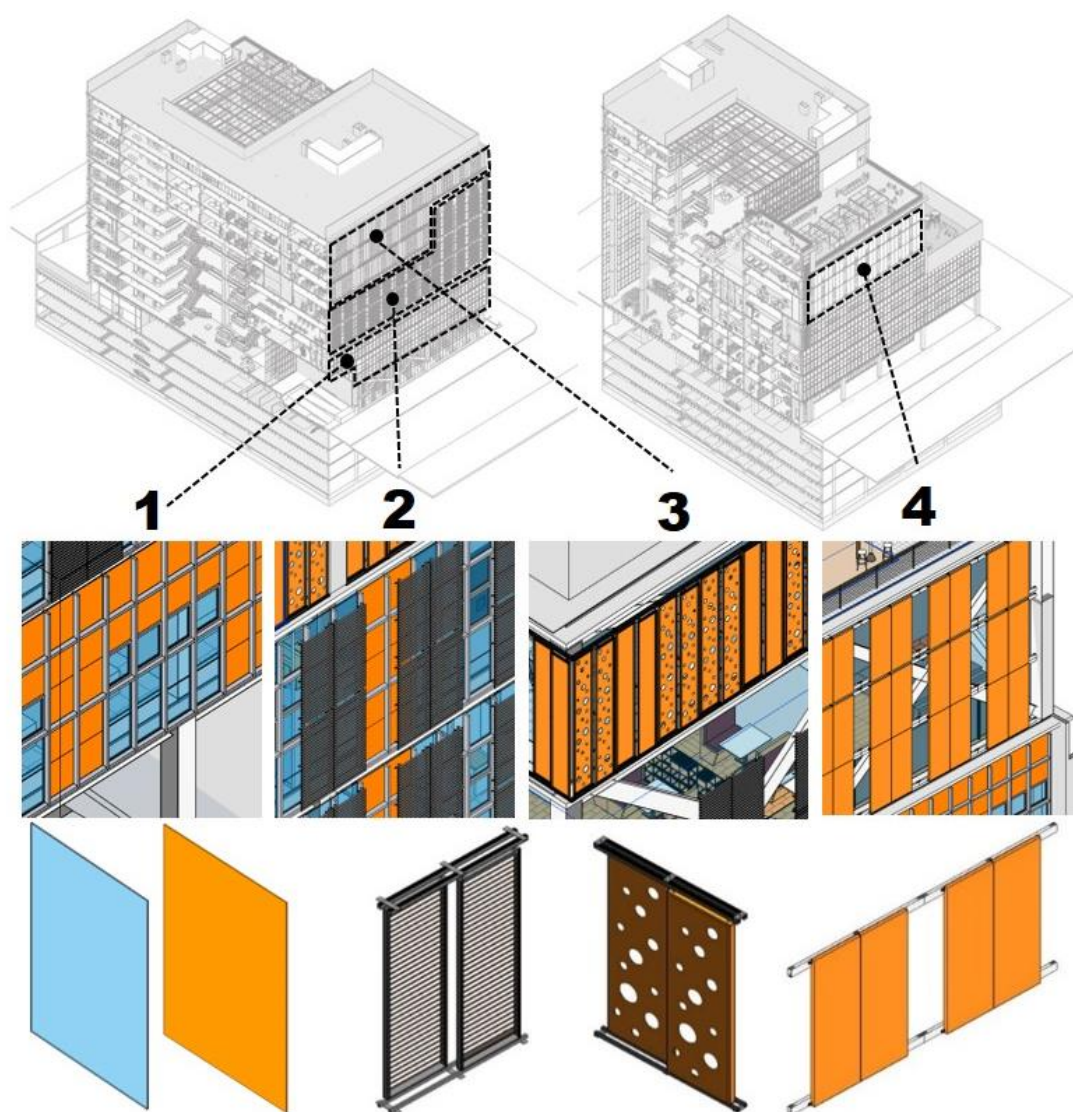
Tipos de fachadas elegidas según la orientación ideal.
